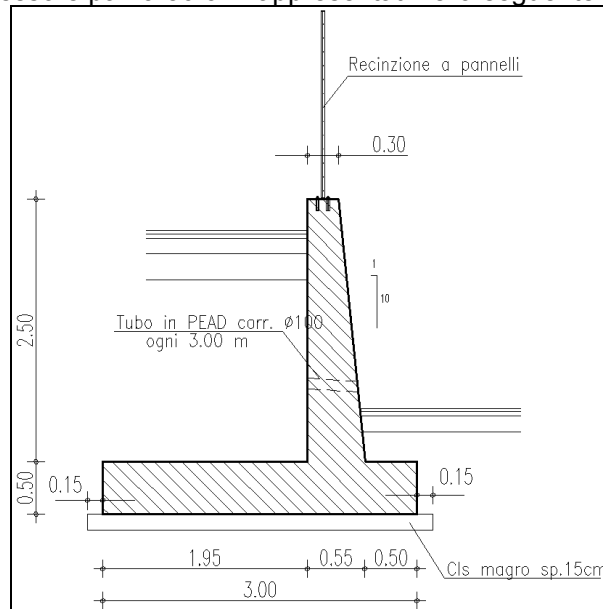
Sezione trasversale muro di contenimento H = 2.50 m
